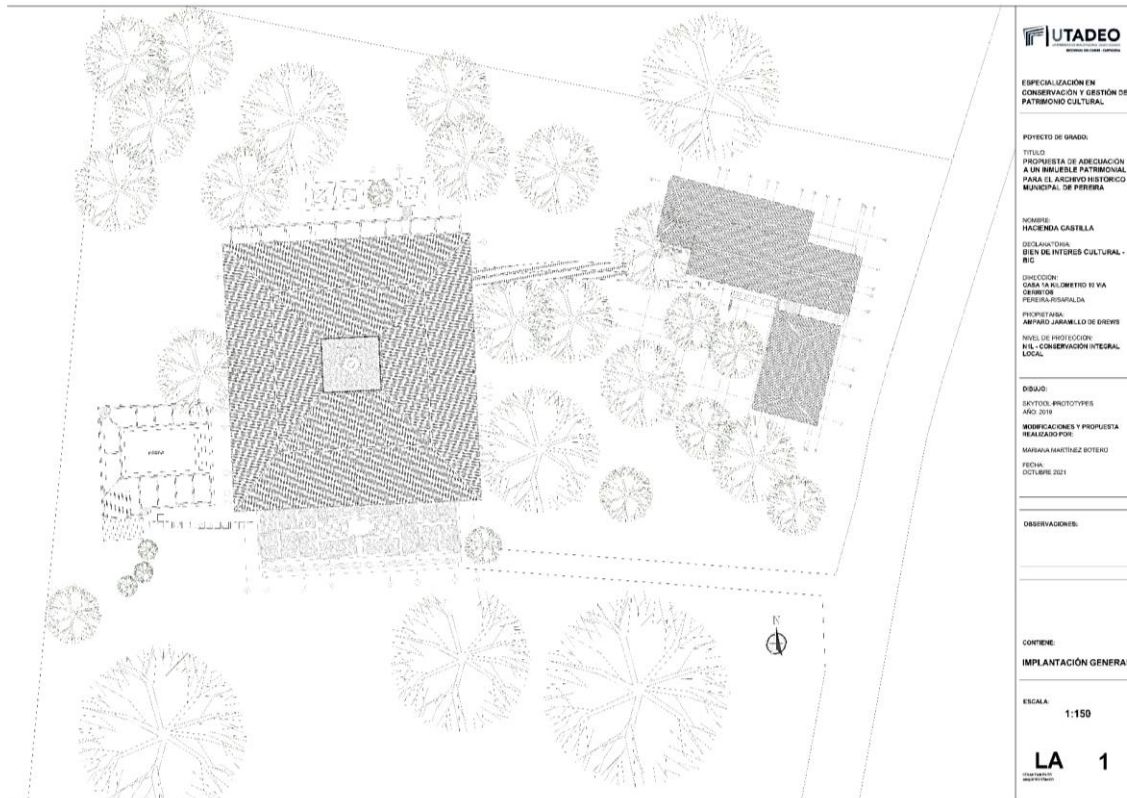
Levantamiento arquitectónico- Implantación general. Fuente: Propia
